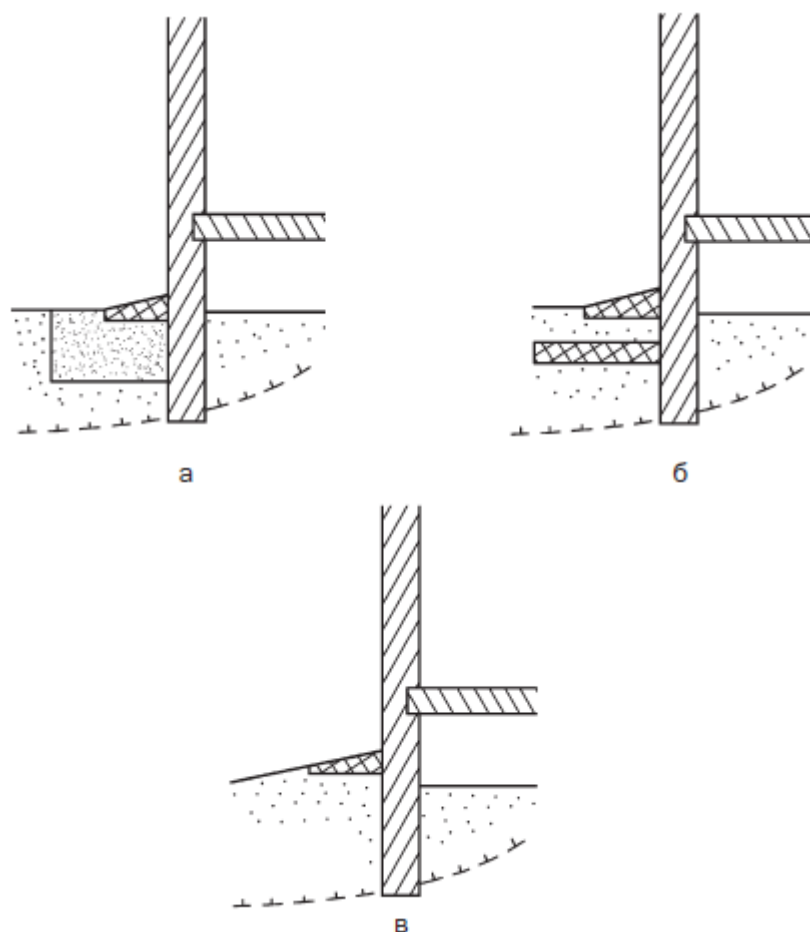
Способы уменьшения глубины промерзания под фундаментом: а – замена грунта; б – укладка утеплителя; в – подсыпка грунта
